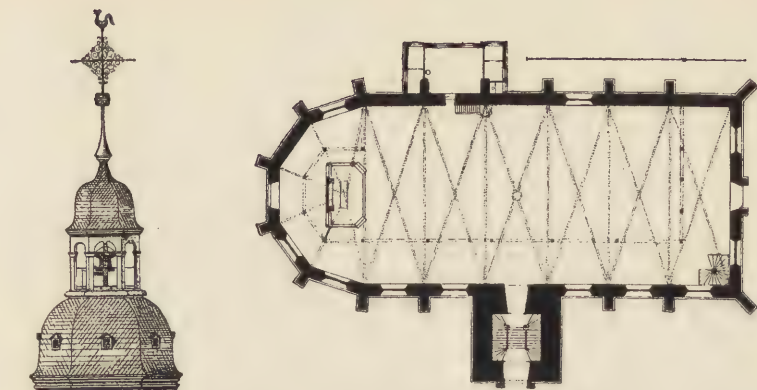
Katharinenkirche zu Frankfurt a. M. Grundriss.
